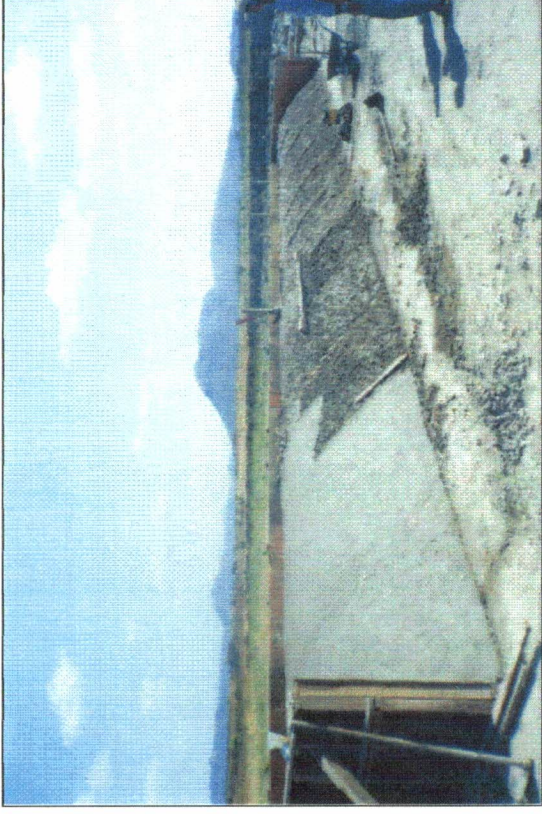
Concretagem com acabamento do perfil Creager entre estaca 85 e 86.
